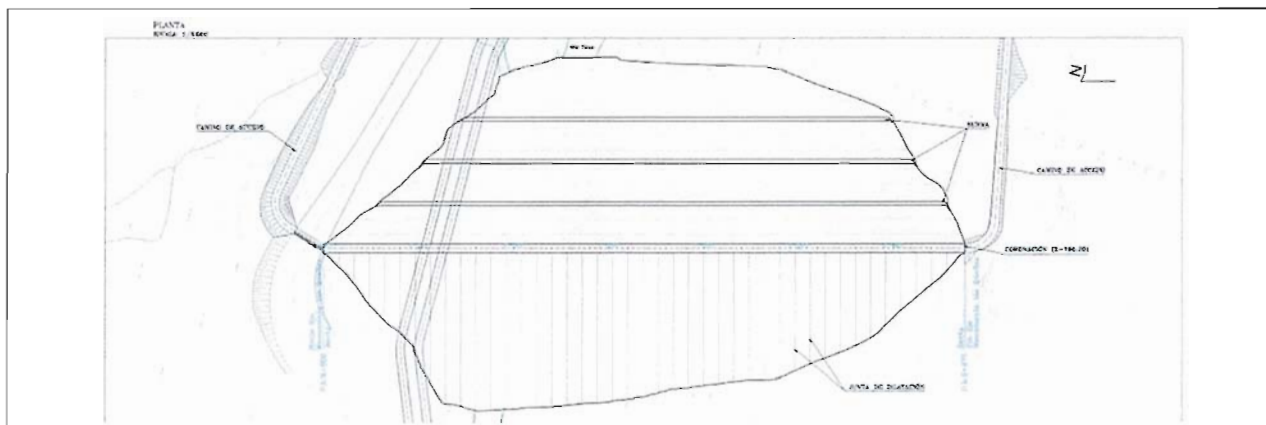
Plano de Planta. Alternativa Los Queñes
